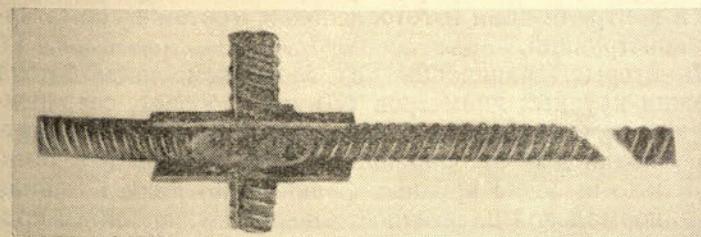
Узел арматурных конструкций из стержней диаметром 50 мм, сваренный ванным способом; разрушение по основному металлу с образованием шейки; слева — вспомогательный стержень; предел прочности 54,8 кг/мм<sup>2</sup>
